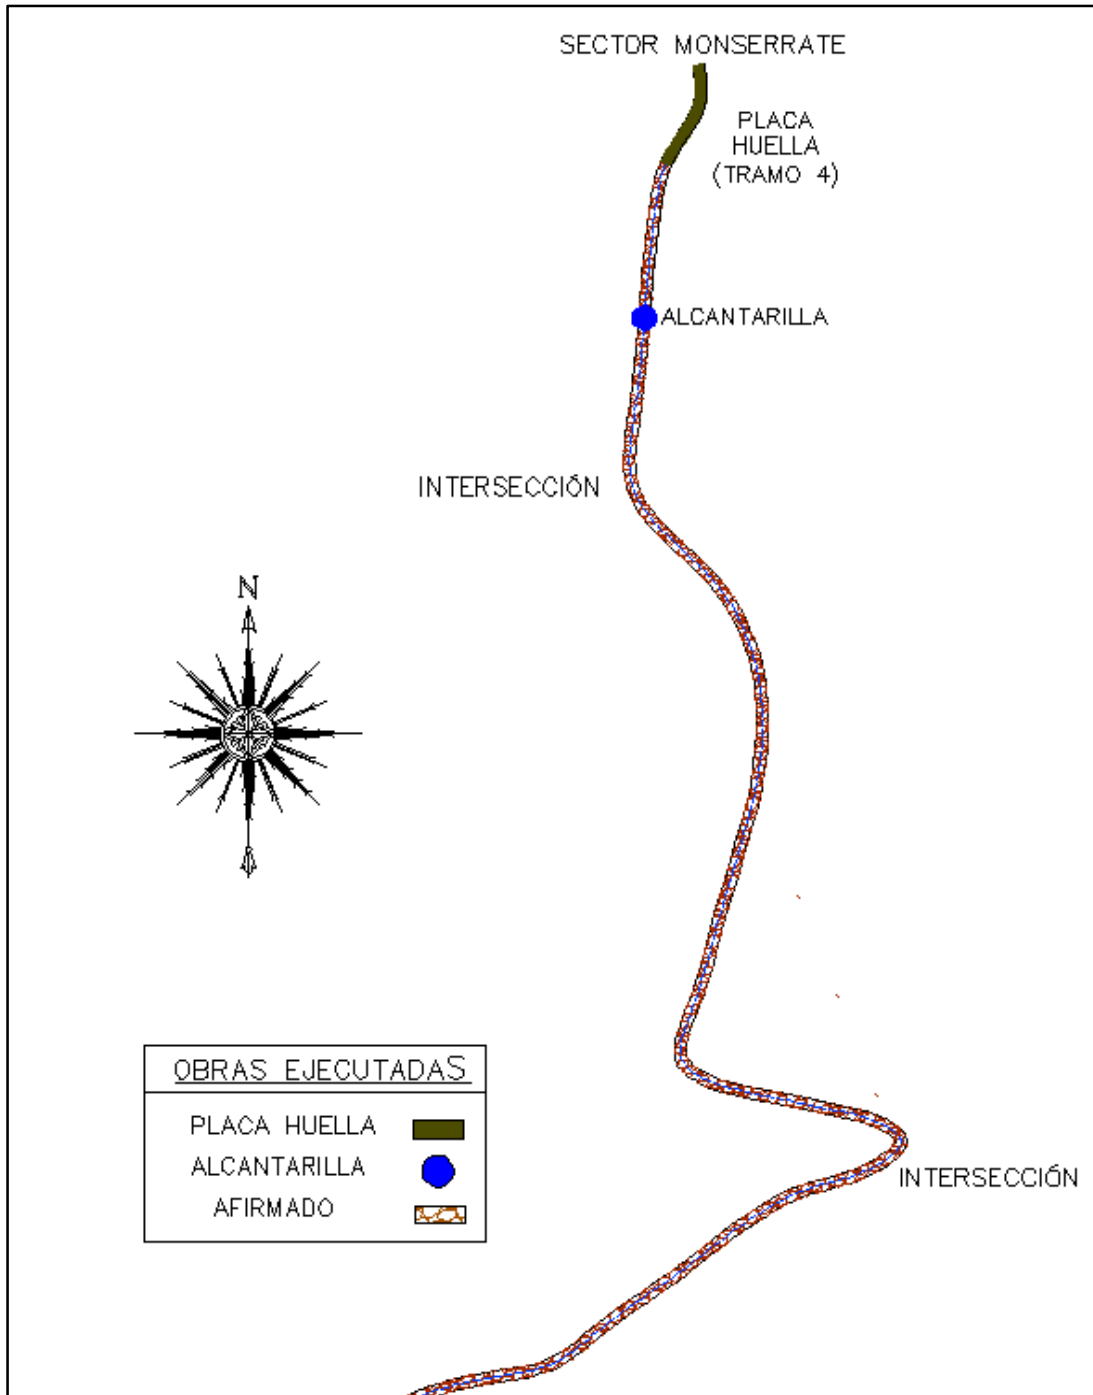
Obras ejecutadas en la parte baja de la vereda Santa Helena-sector Soledad
